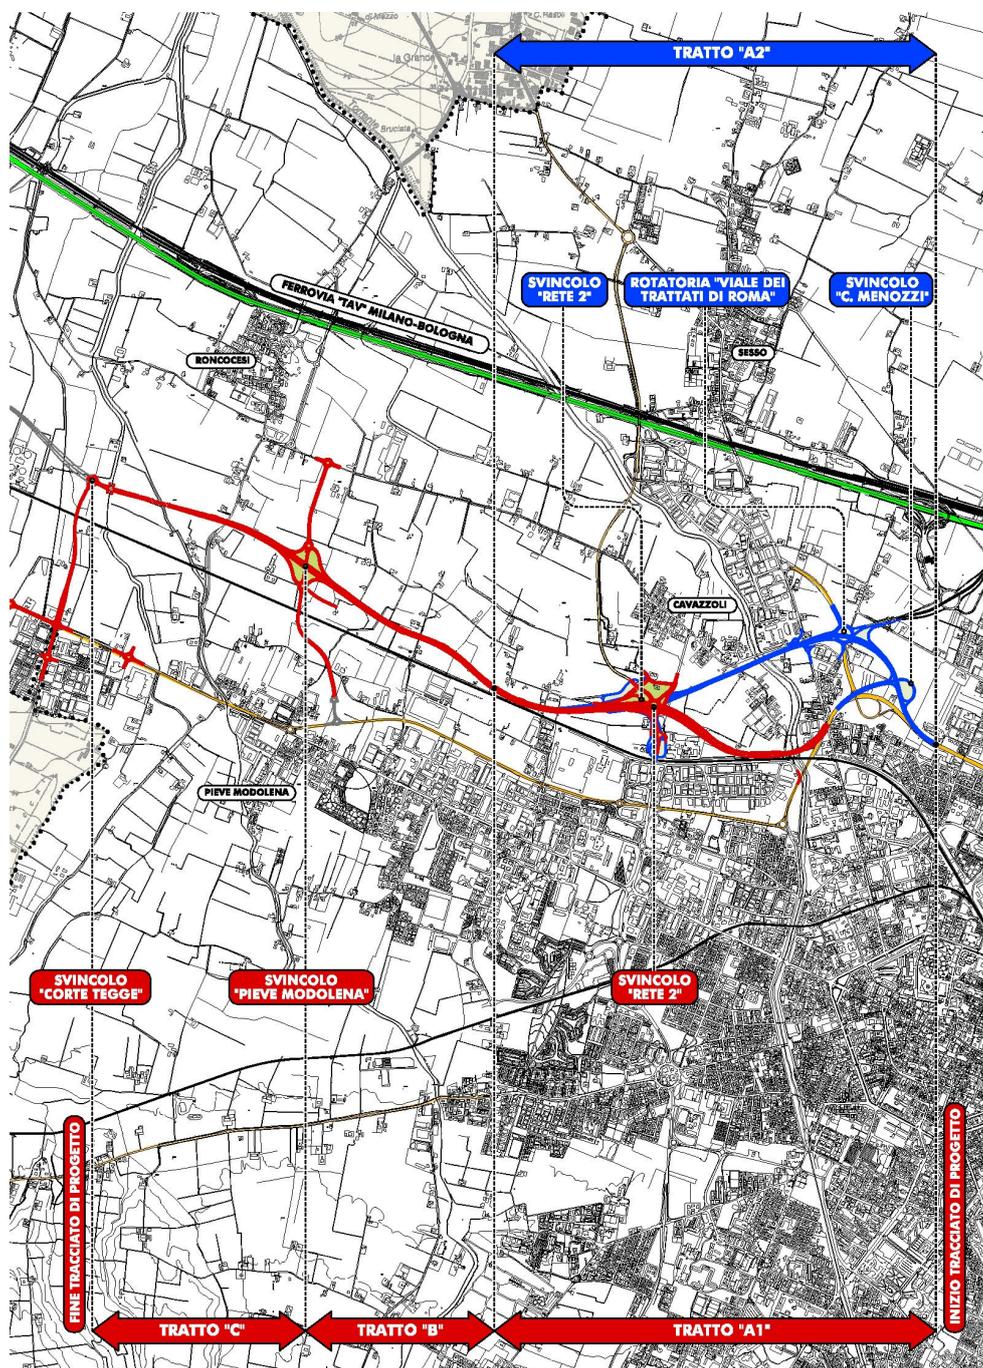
Planimetria di raffronto tra il “tracciato sud” ed il “tracciato Nord”
